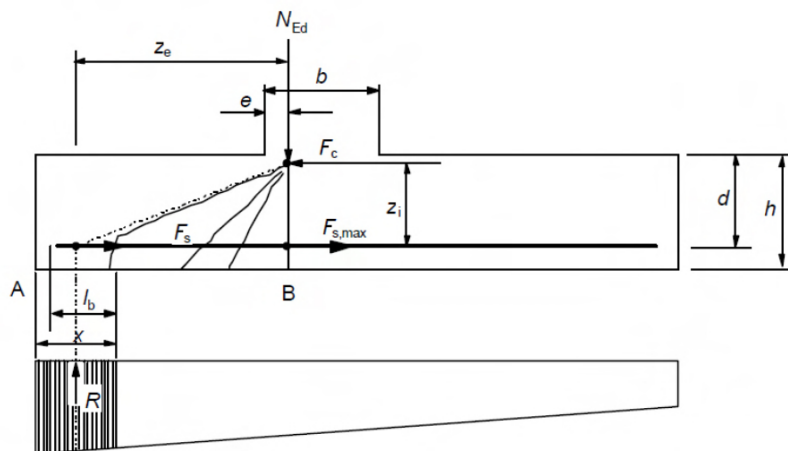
Modelo de fuerza de tracción con respecto a las fisuras inclinadas
